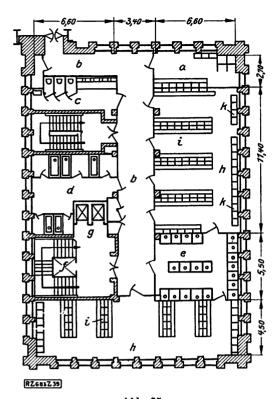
Verwaltungsgebäude. Grundriß des 3. Obergeschosses.
